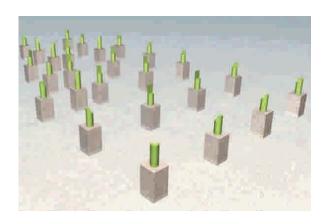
14 : Distribución de pilotes de madera impregnados e incorporados a los cimientos de hormigón, que transmiten las cargas al terreno.
